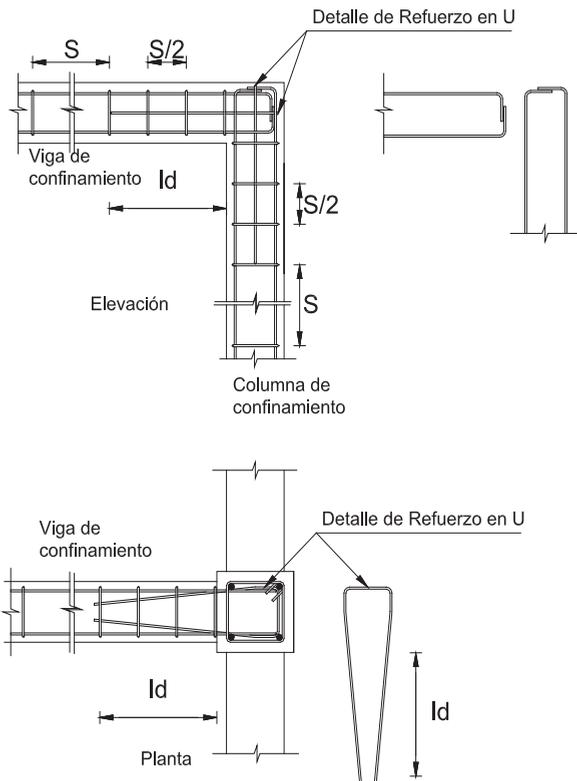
Detallamiento para vigas de confinamiento (riostras)
